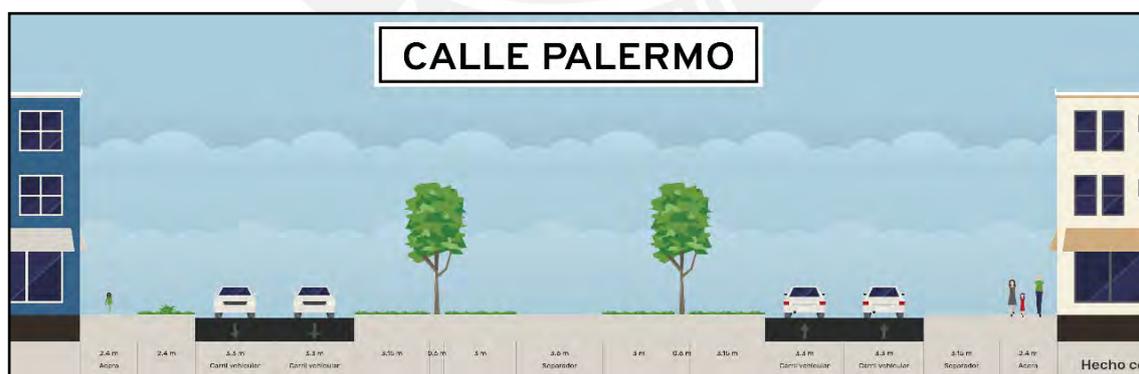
Situación actual de la sección típica de la Calle Palermo.
